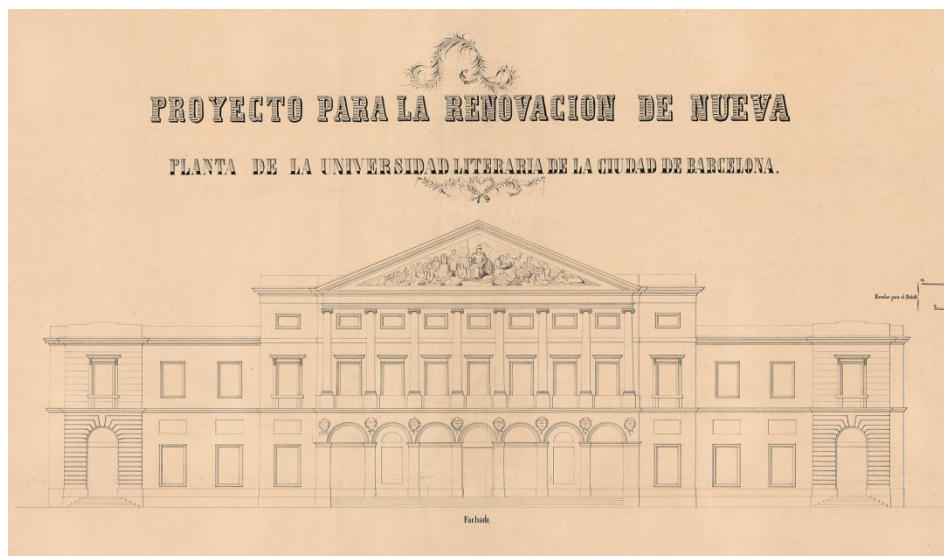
Alzado de la fachada principal. Detalle de la fig. 8
